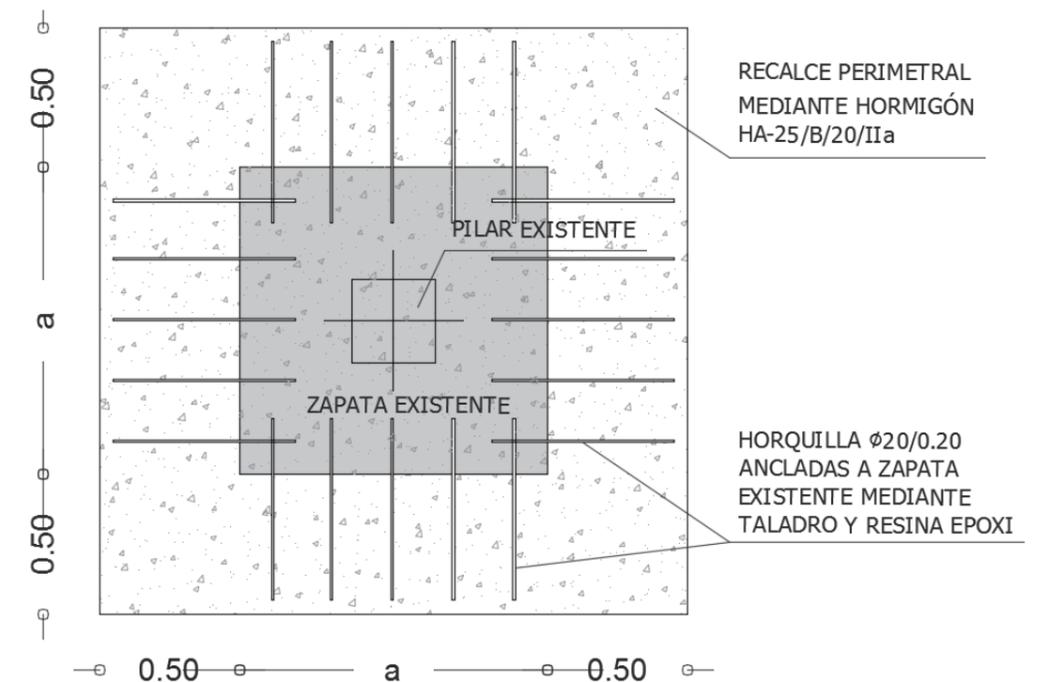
Planta de la zapata reforzada. 2018. Elaboración propia
